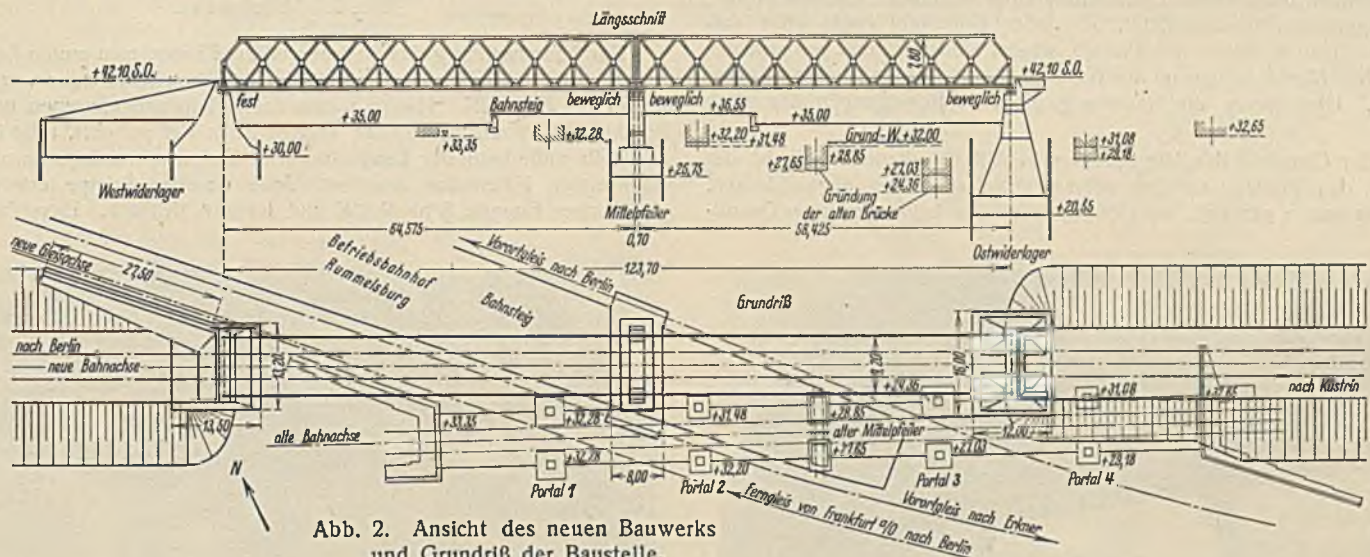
Ansicht des neuen Bauwerks und Grundriß der Baustelle.
